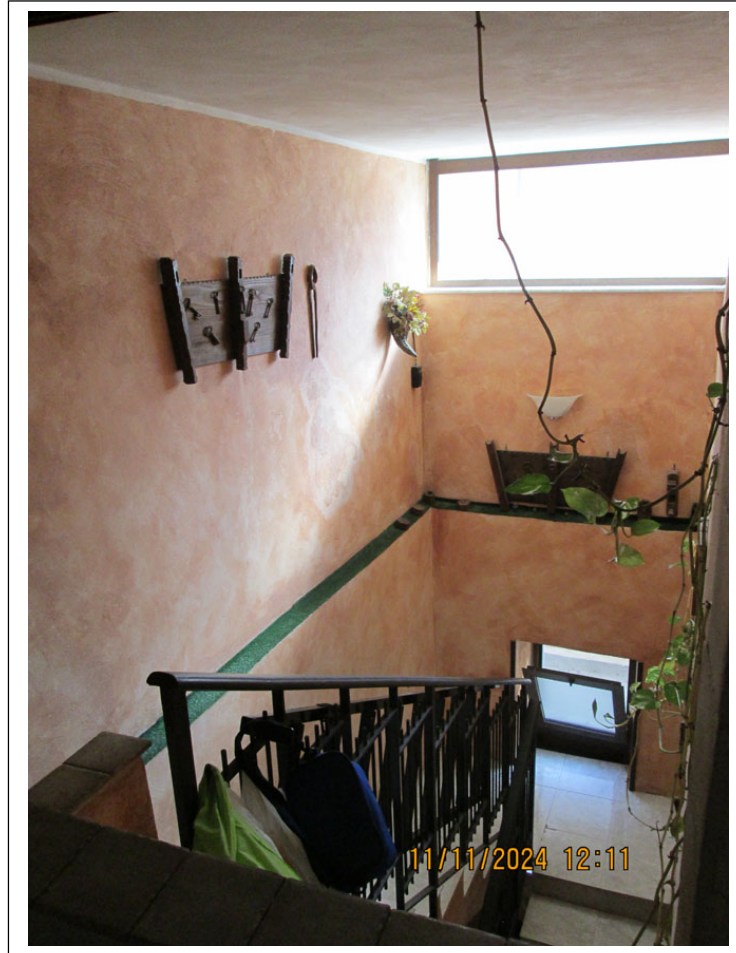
Scala del fabbricato che conduce all'immobile del secondo piano
